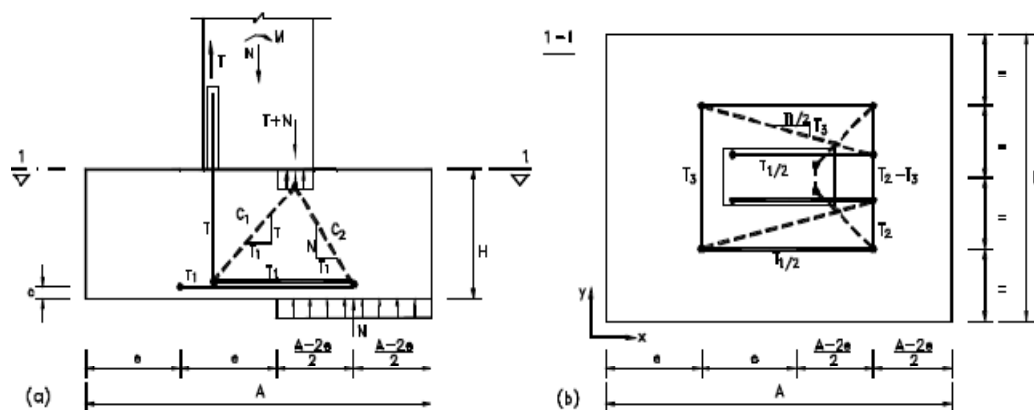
Ligação pilar - fundação com armaduras salientes de fundação (extraída de [3])
